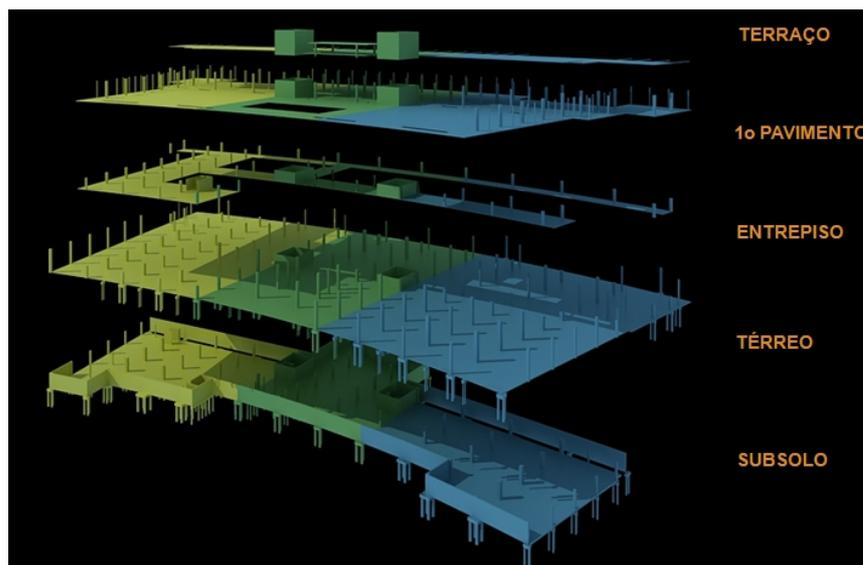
Esquema da estrutura de concreto do terminal
